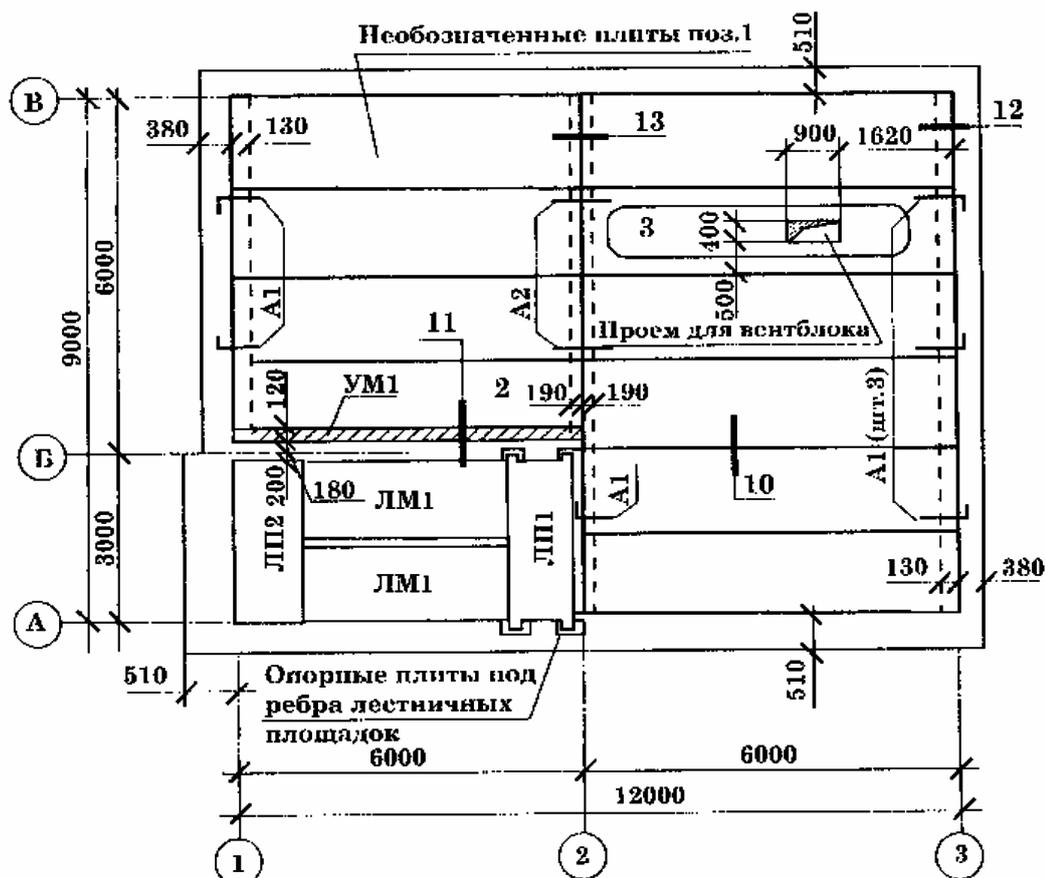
Пример оформления плана перекрытий на отм. ± 3.000
